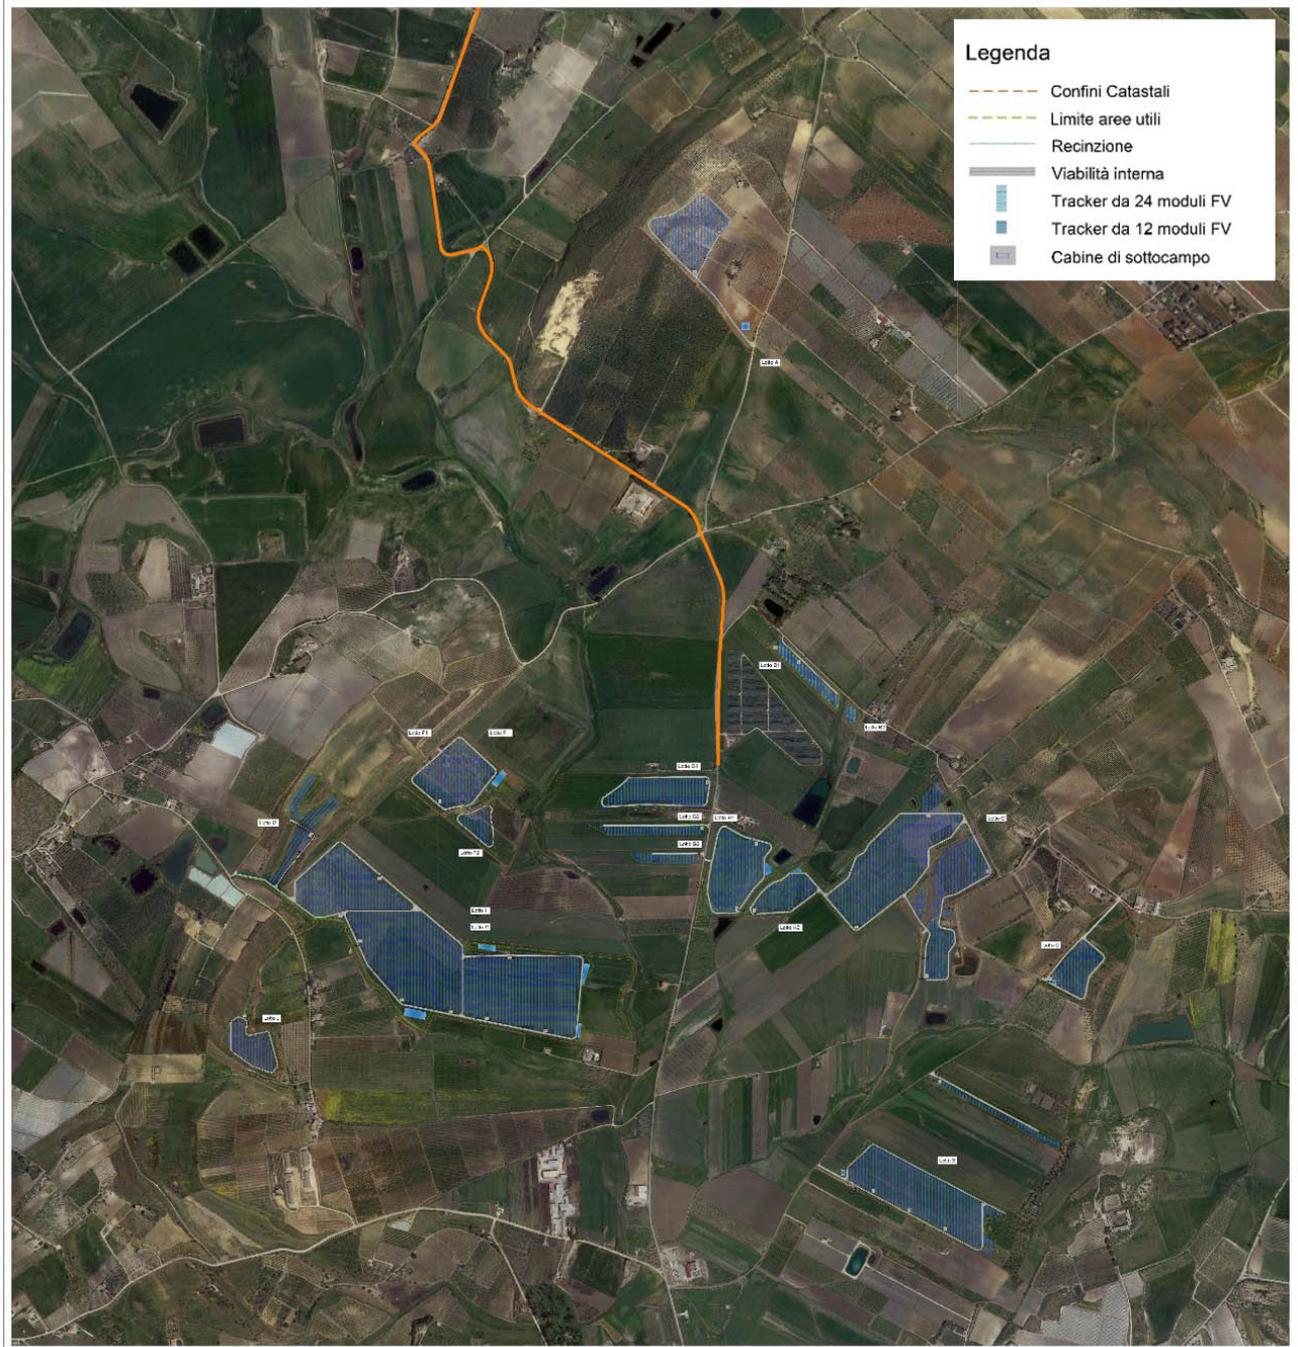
Layout dell'impianto agrovoltaico su ortofoto
